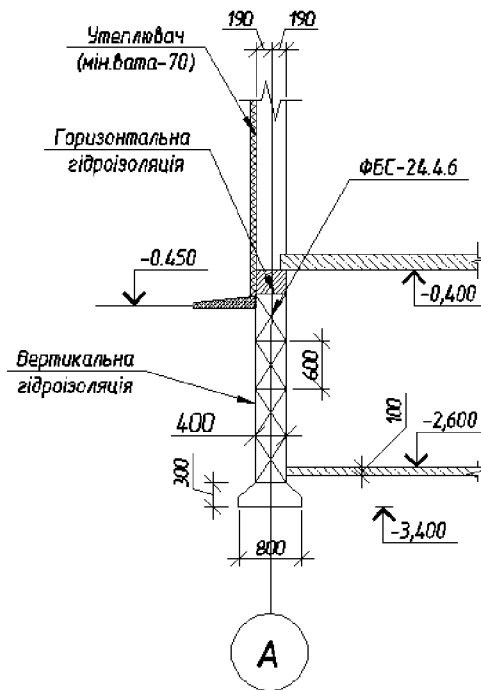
Розрахункова схема до визначення фундаменту у перерізі 1-1
